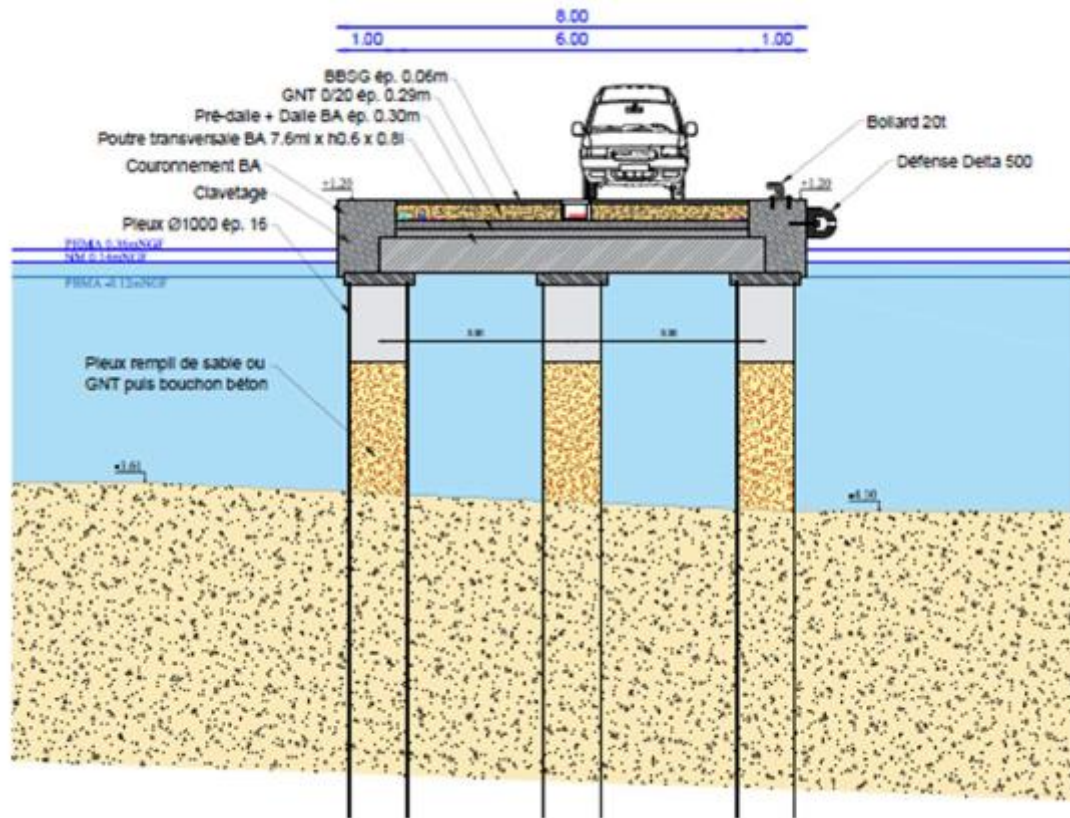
Coupe de principe de l'ouvrage sur pieux (SUEZ, AVP 2023)
